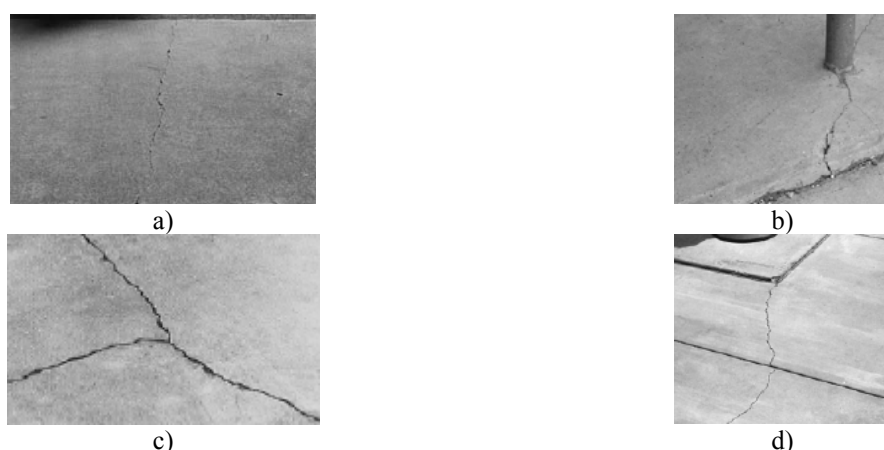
Tipos mais frequentes de fendas: a) retracção plástica; b) deficiente construção da junta de dessolidarização; c) deficiente dimensionamento/construção da sub-base e/ou do pavimento; d) inadequado traçado da junta
